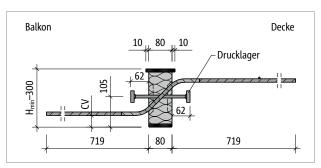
Schöck Isokorb® T Typ QP-V6: Produktschnitt
